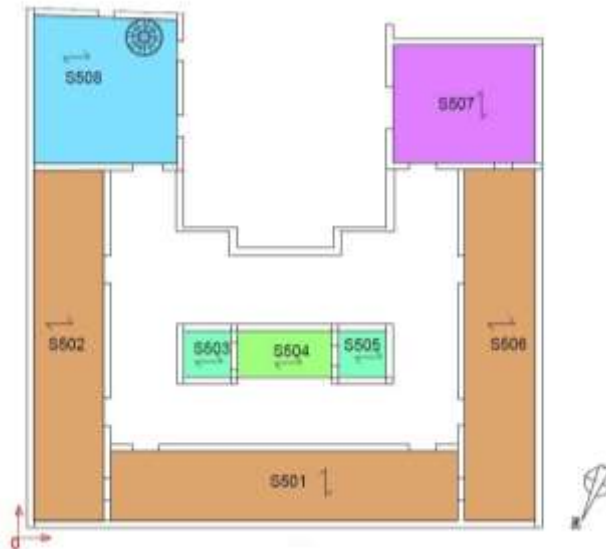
Pianta chiave dei solai copertura del quinto piano.
